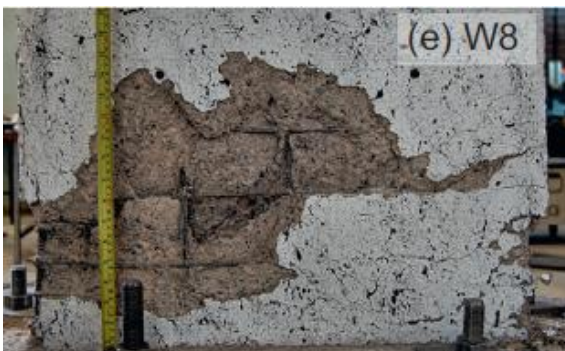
Vista frontal de la falla – Muro 5, adaptada de [3].
